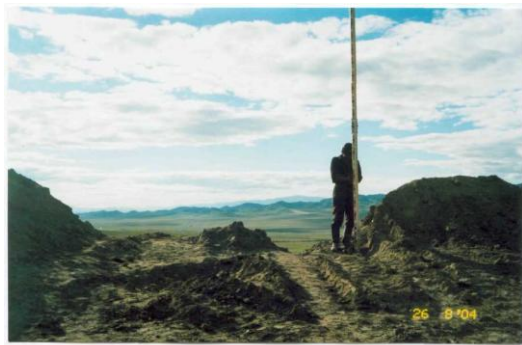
Следы разрушения породного вала и положение автосамосвала под откосом
